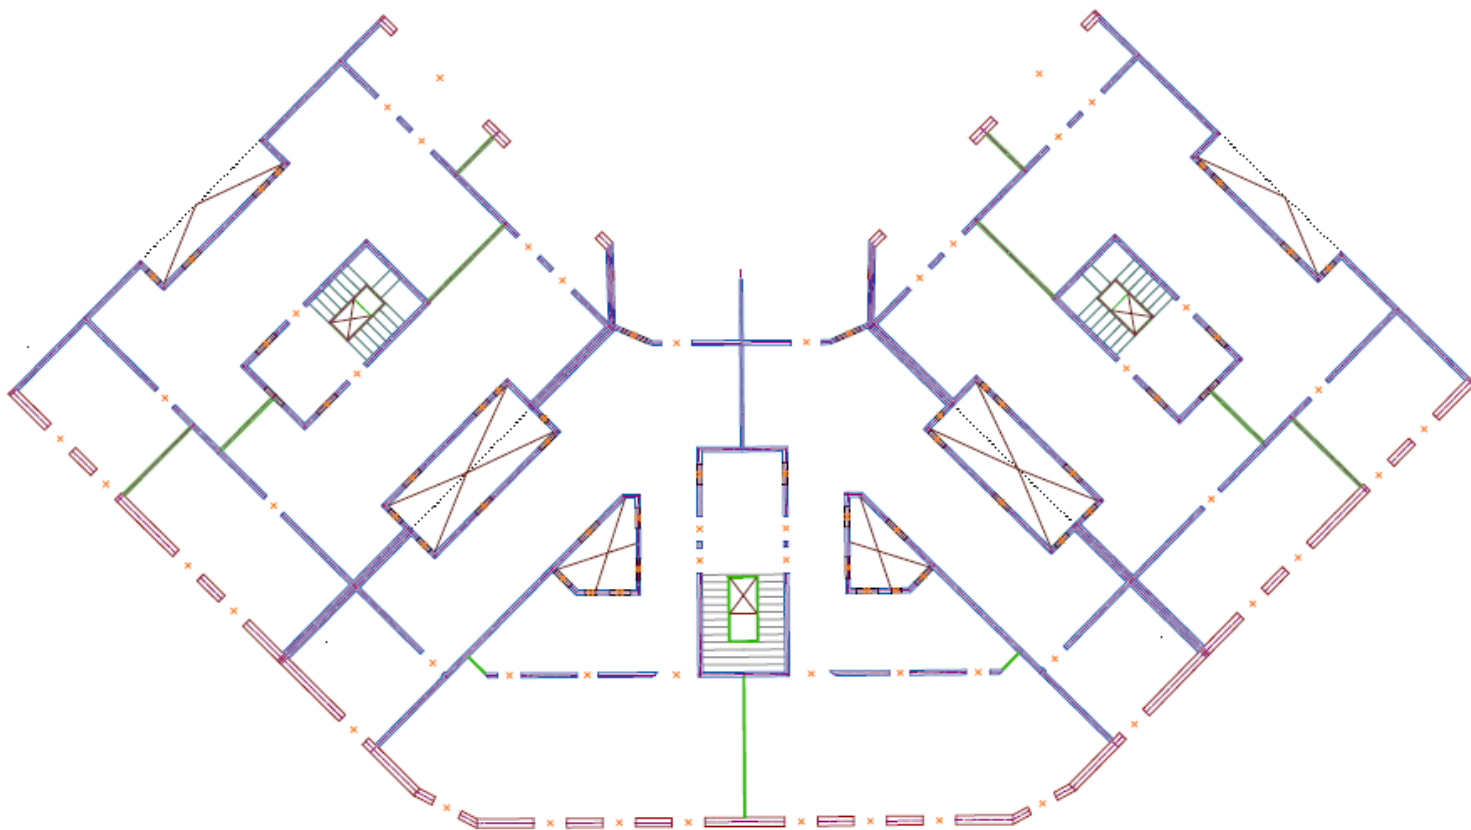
Plànol CAD planta tipus del conjunt dels edificis ED01, ED02, ED01¹
